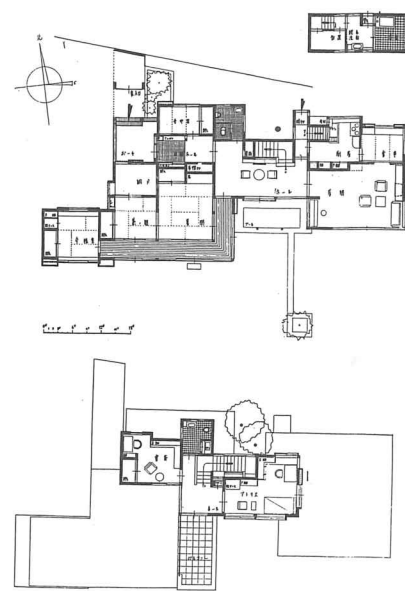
金子邸 1階・地階平面図(上)、2階平面図(下)
